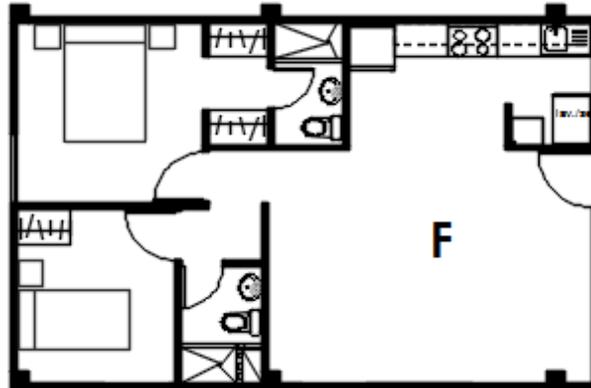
Planta arquitectónica departamento F conjunto residencial "Praderas de Bemani".
